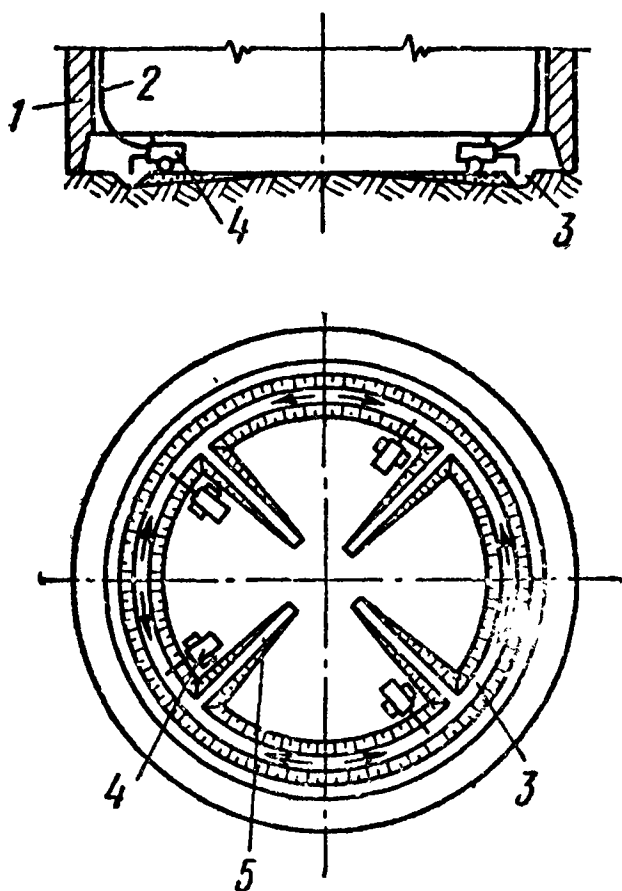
Схема осушения колодца способом открытого водоотлива
